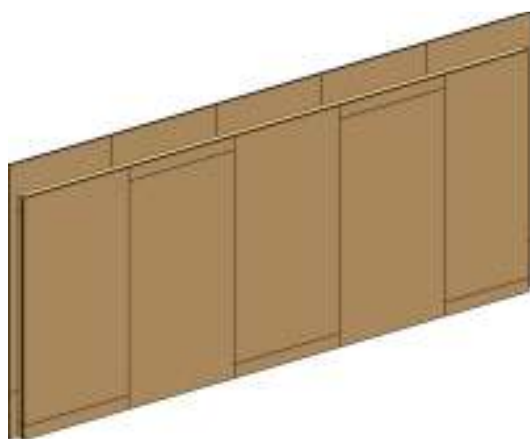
Elemento de parede 1 e 2 revestido a painéis de OSB.
